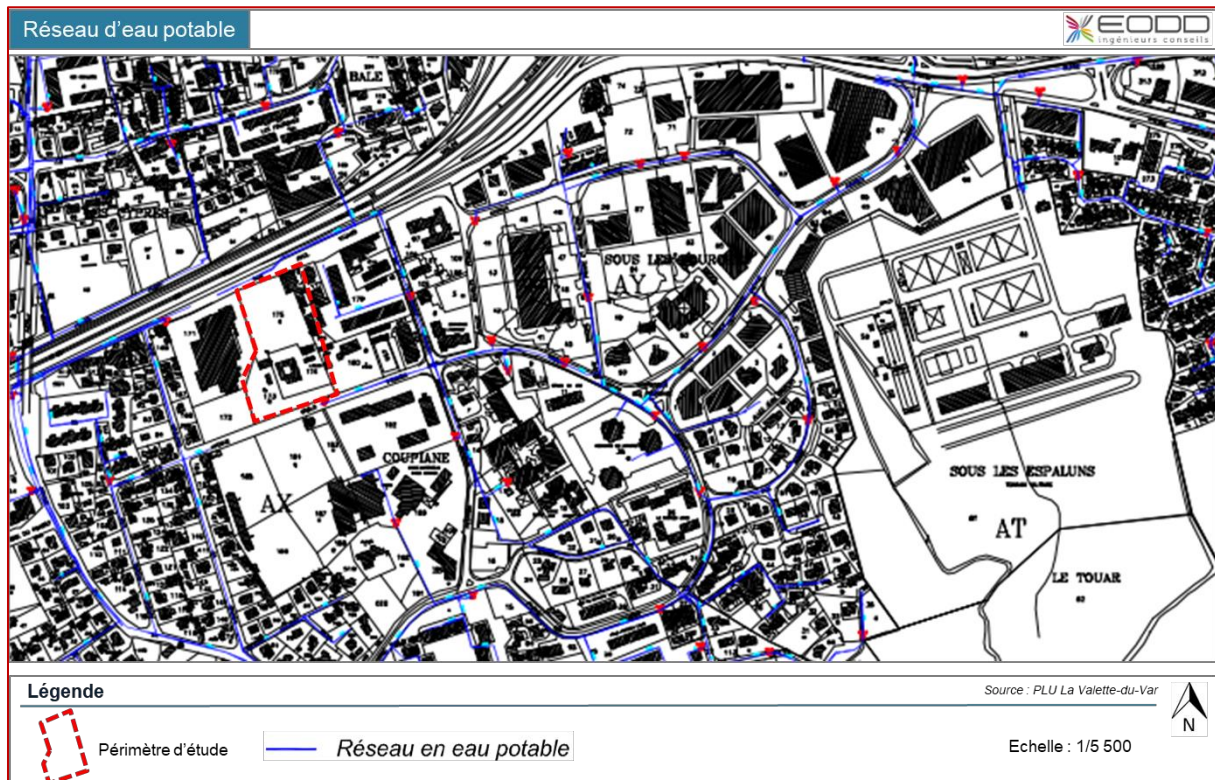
Réseau d'eau potable autour du site (source : PLU)
